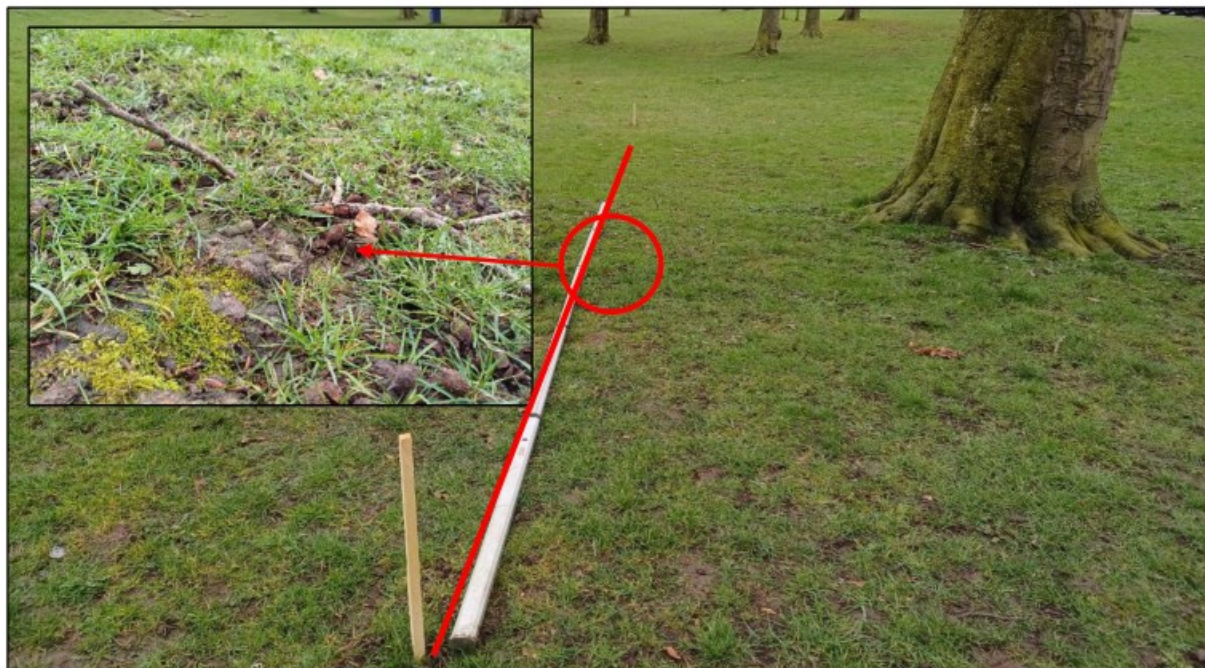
weergave rand geplande ontgraving en ter plaatse aanwezige (forse) oppervlakkige beworteling
